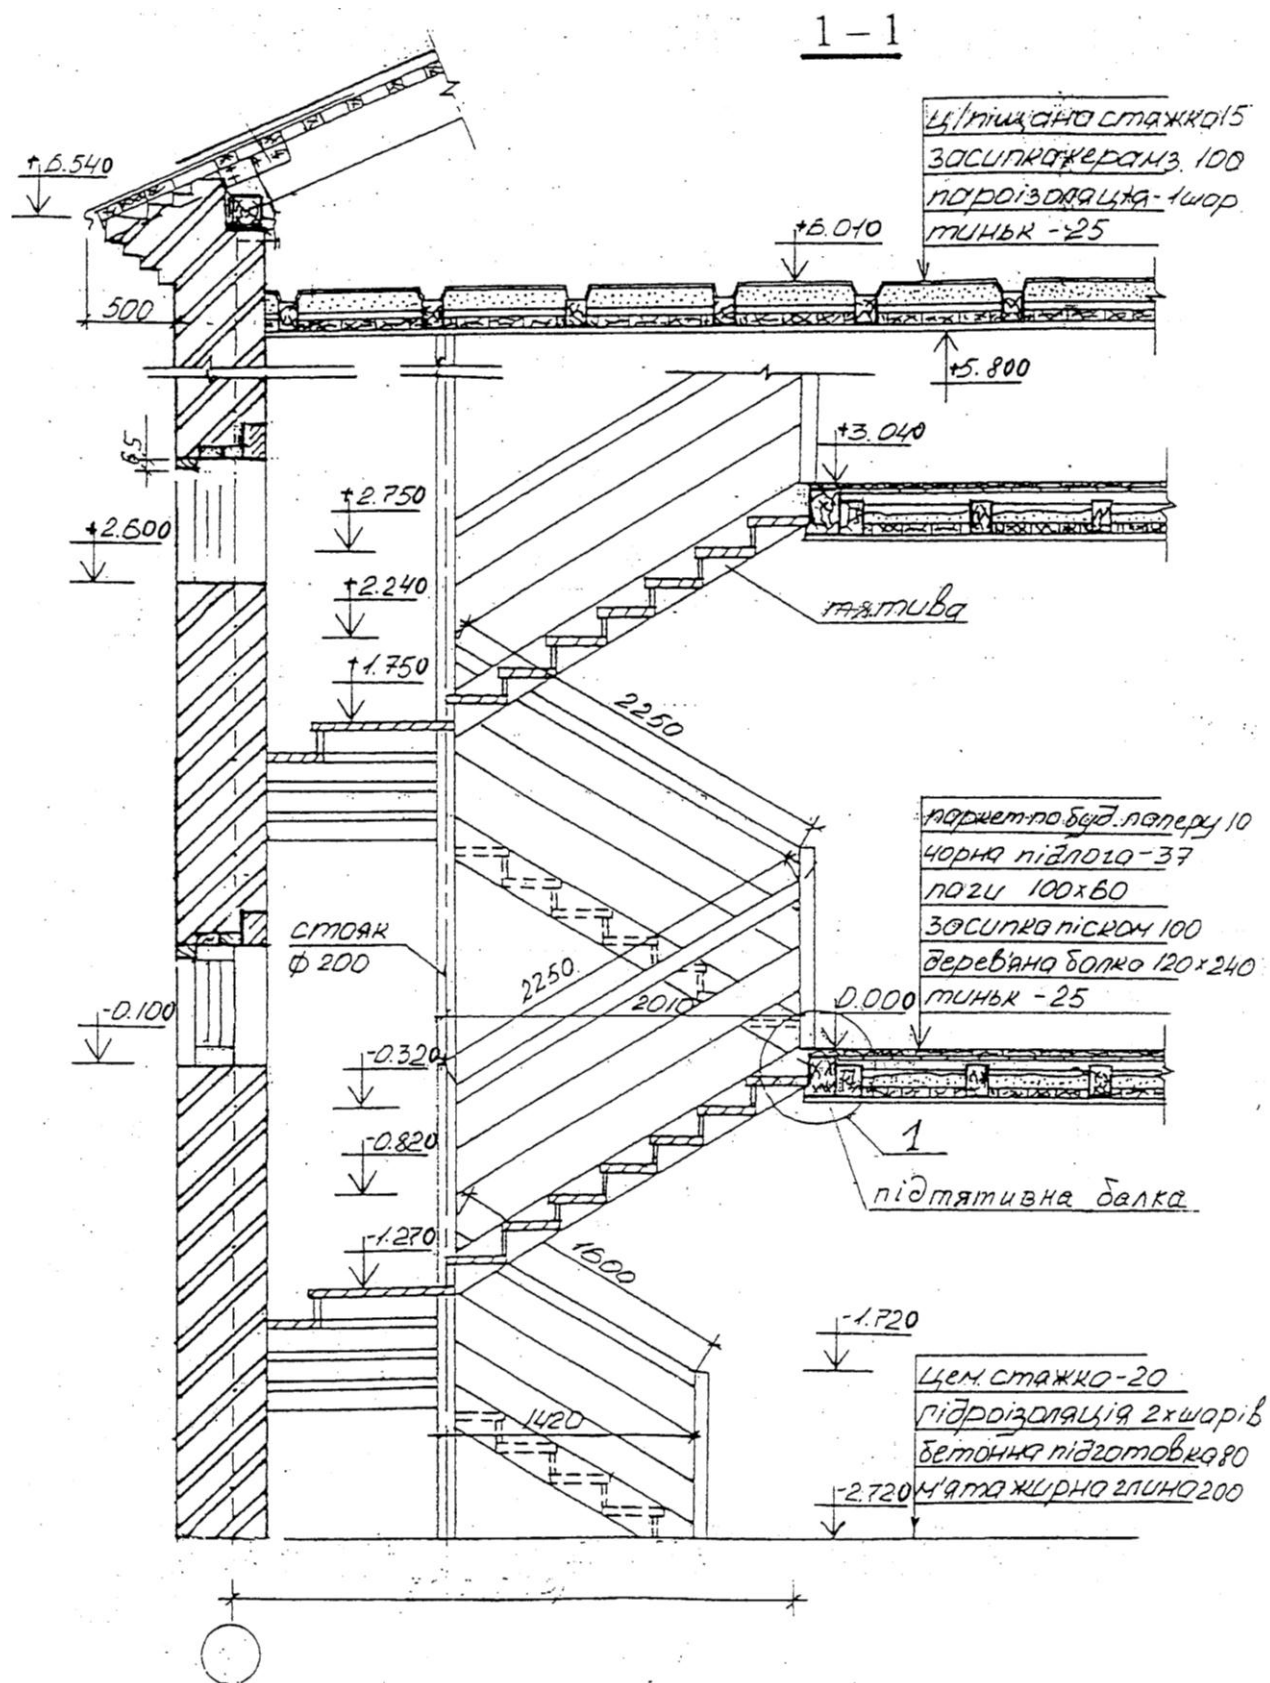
Дерев'яні сходи із забіжними сходишками, розміщені у сходовій клітці (продовження)
